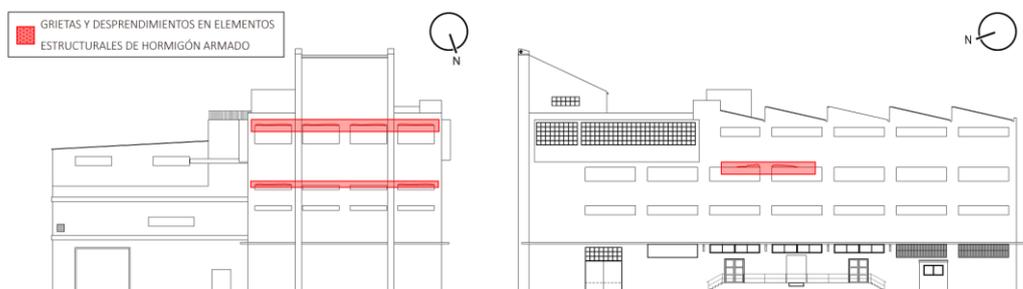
Imagen izquierda. Ubicación de la lesión sobre alzado nordeste. Imagen derecha. Ubicación de los desprendimientos de hormigón armado sobre fachada noroeste. Fuente elaboración propia.
